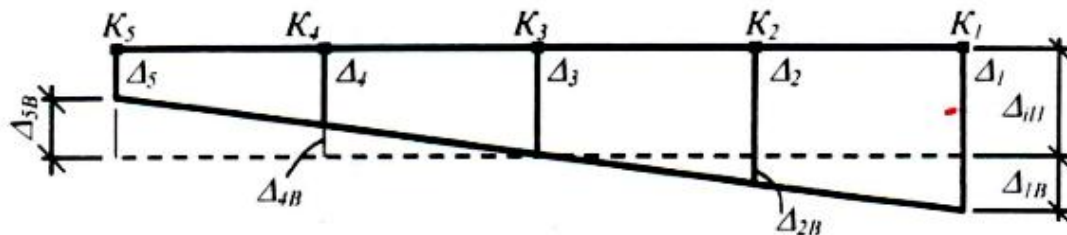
Эпюра перемещений верхних концов колонн каркаса при жесткой кровле.
